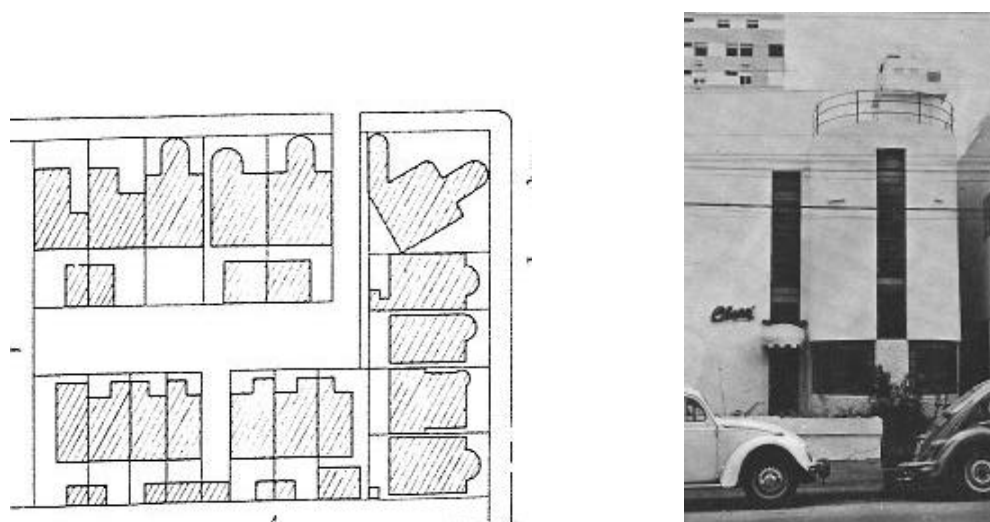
Planta de situação do conjunto do Jardim Paulista e fachada de uma das casas do conjunto.
